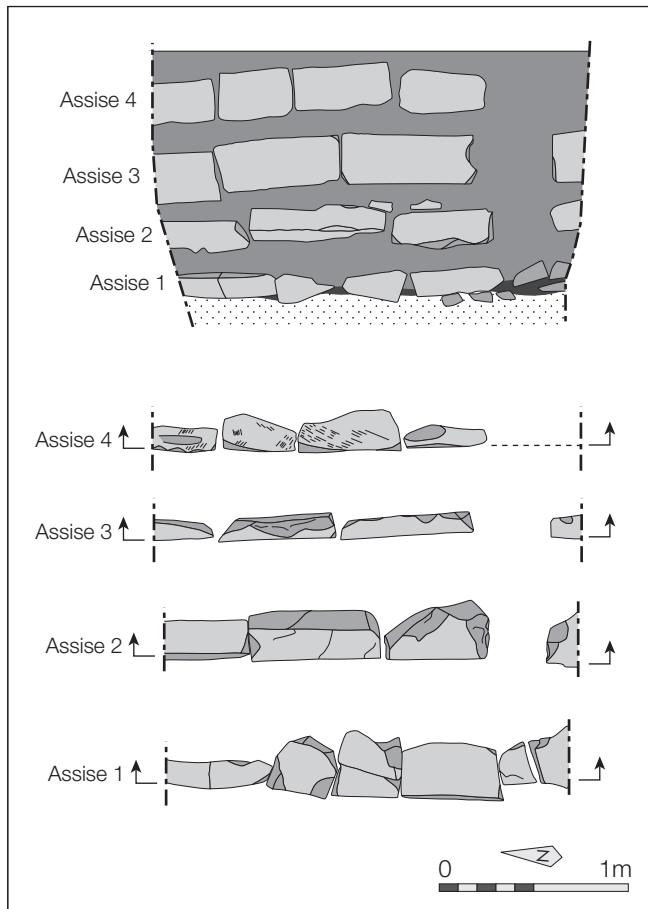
Relevé de façade du parement et plans des différentes assises (sondage 1)
